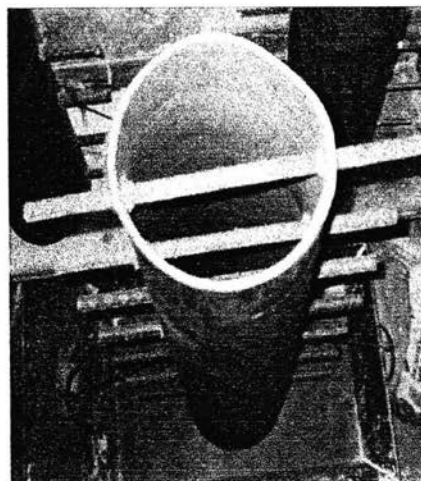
Diseño de las probetas de concreto antes de la colada.
